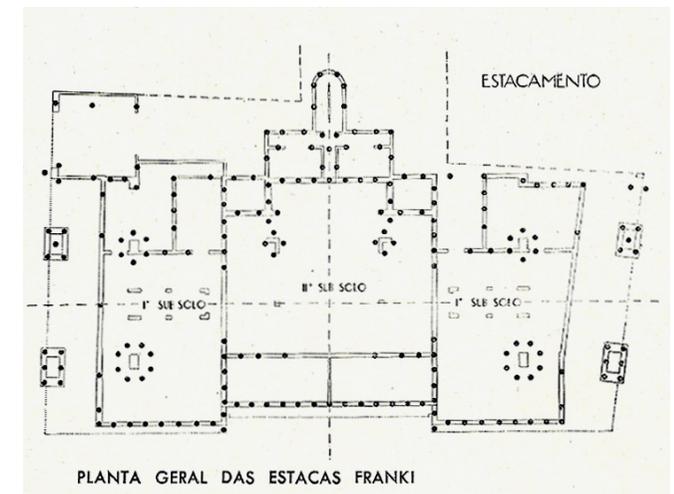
planta Geral das Estacas Franki – ACRJ
